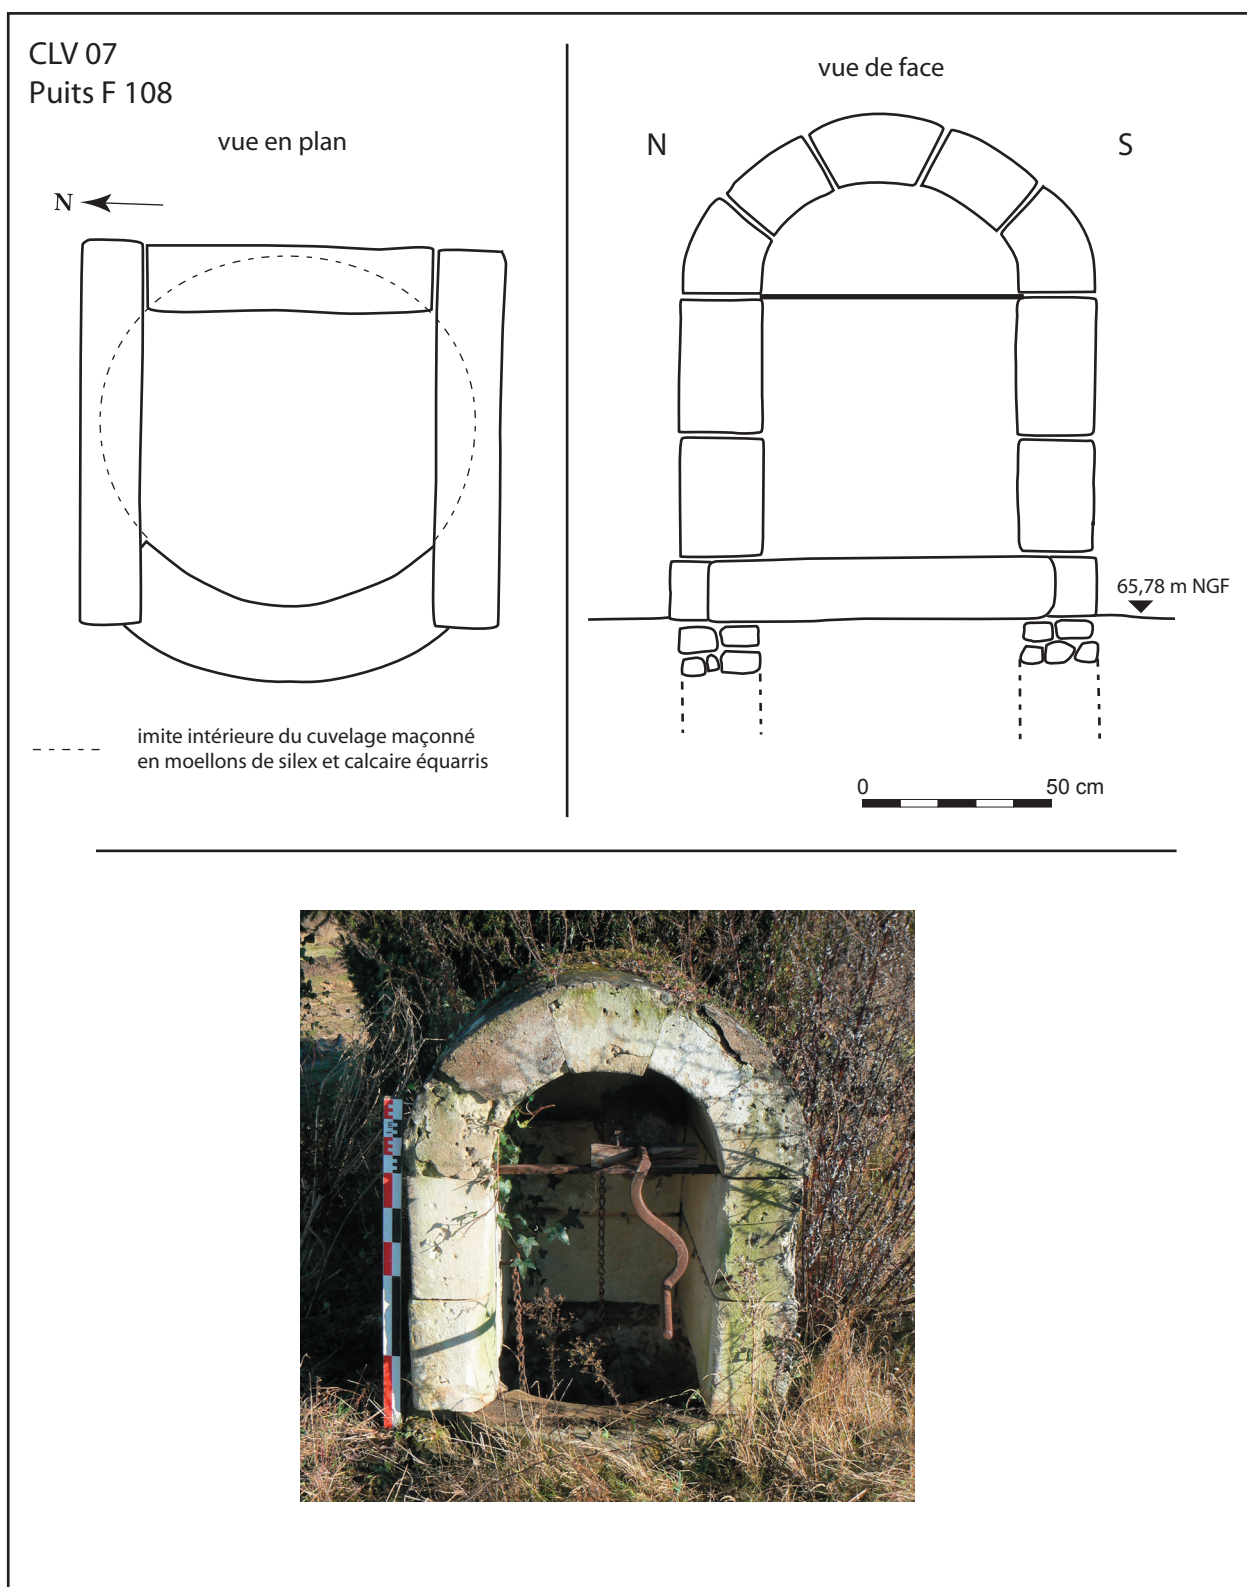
plan et photographie du puits contemporain F108 (M. Gaultier, M. Laurens-Berge - SADIL)
